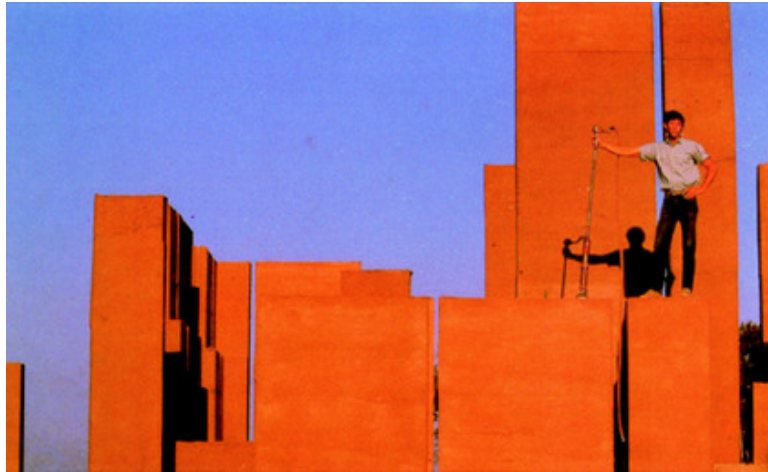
Painéis de solo-cimento executado pelo arquiteto David Easton.
